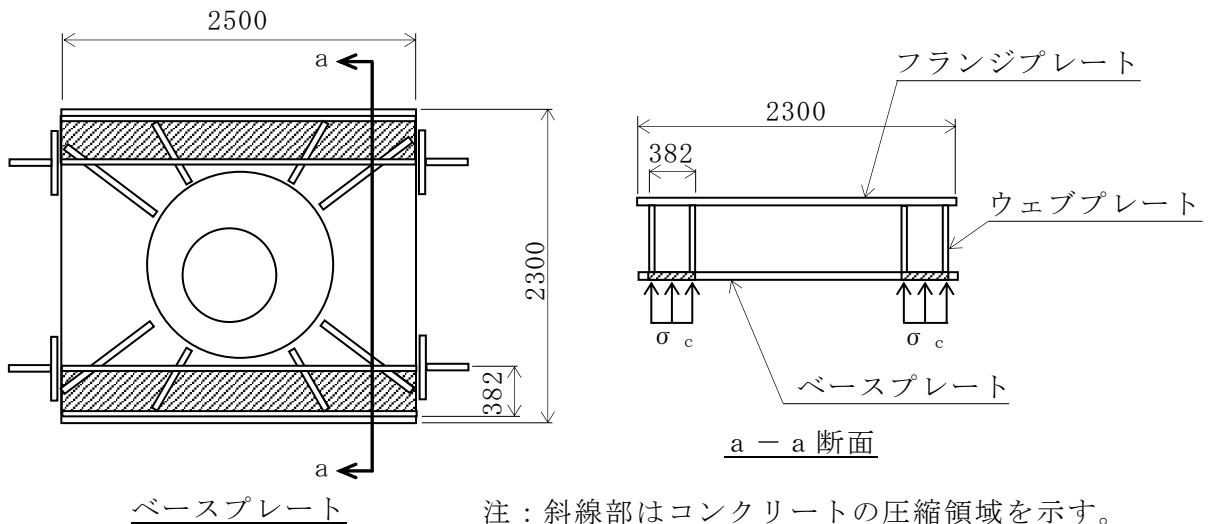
コンクリートに作用する圧縮力の概要図 (単位: mm)
